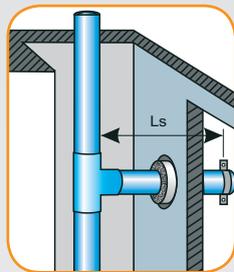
Возможность перемещения соединительного трубопровода в месте прохода через стену.
